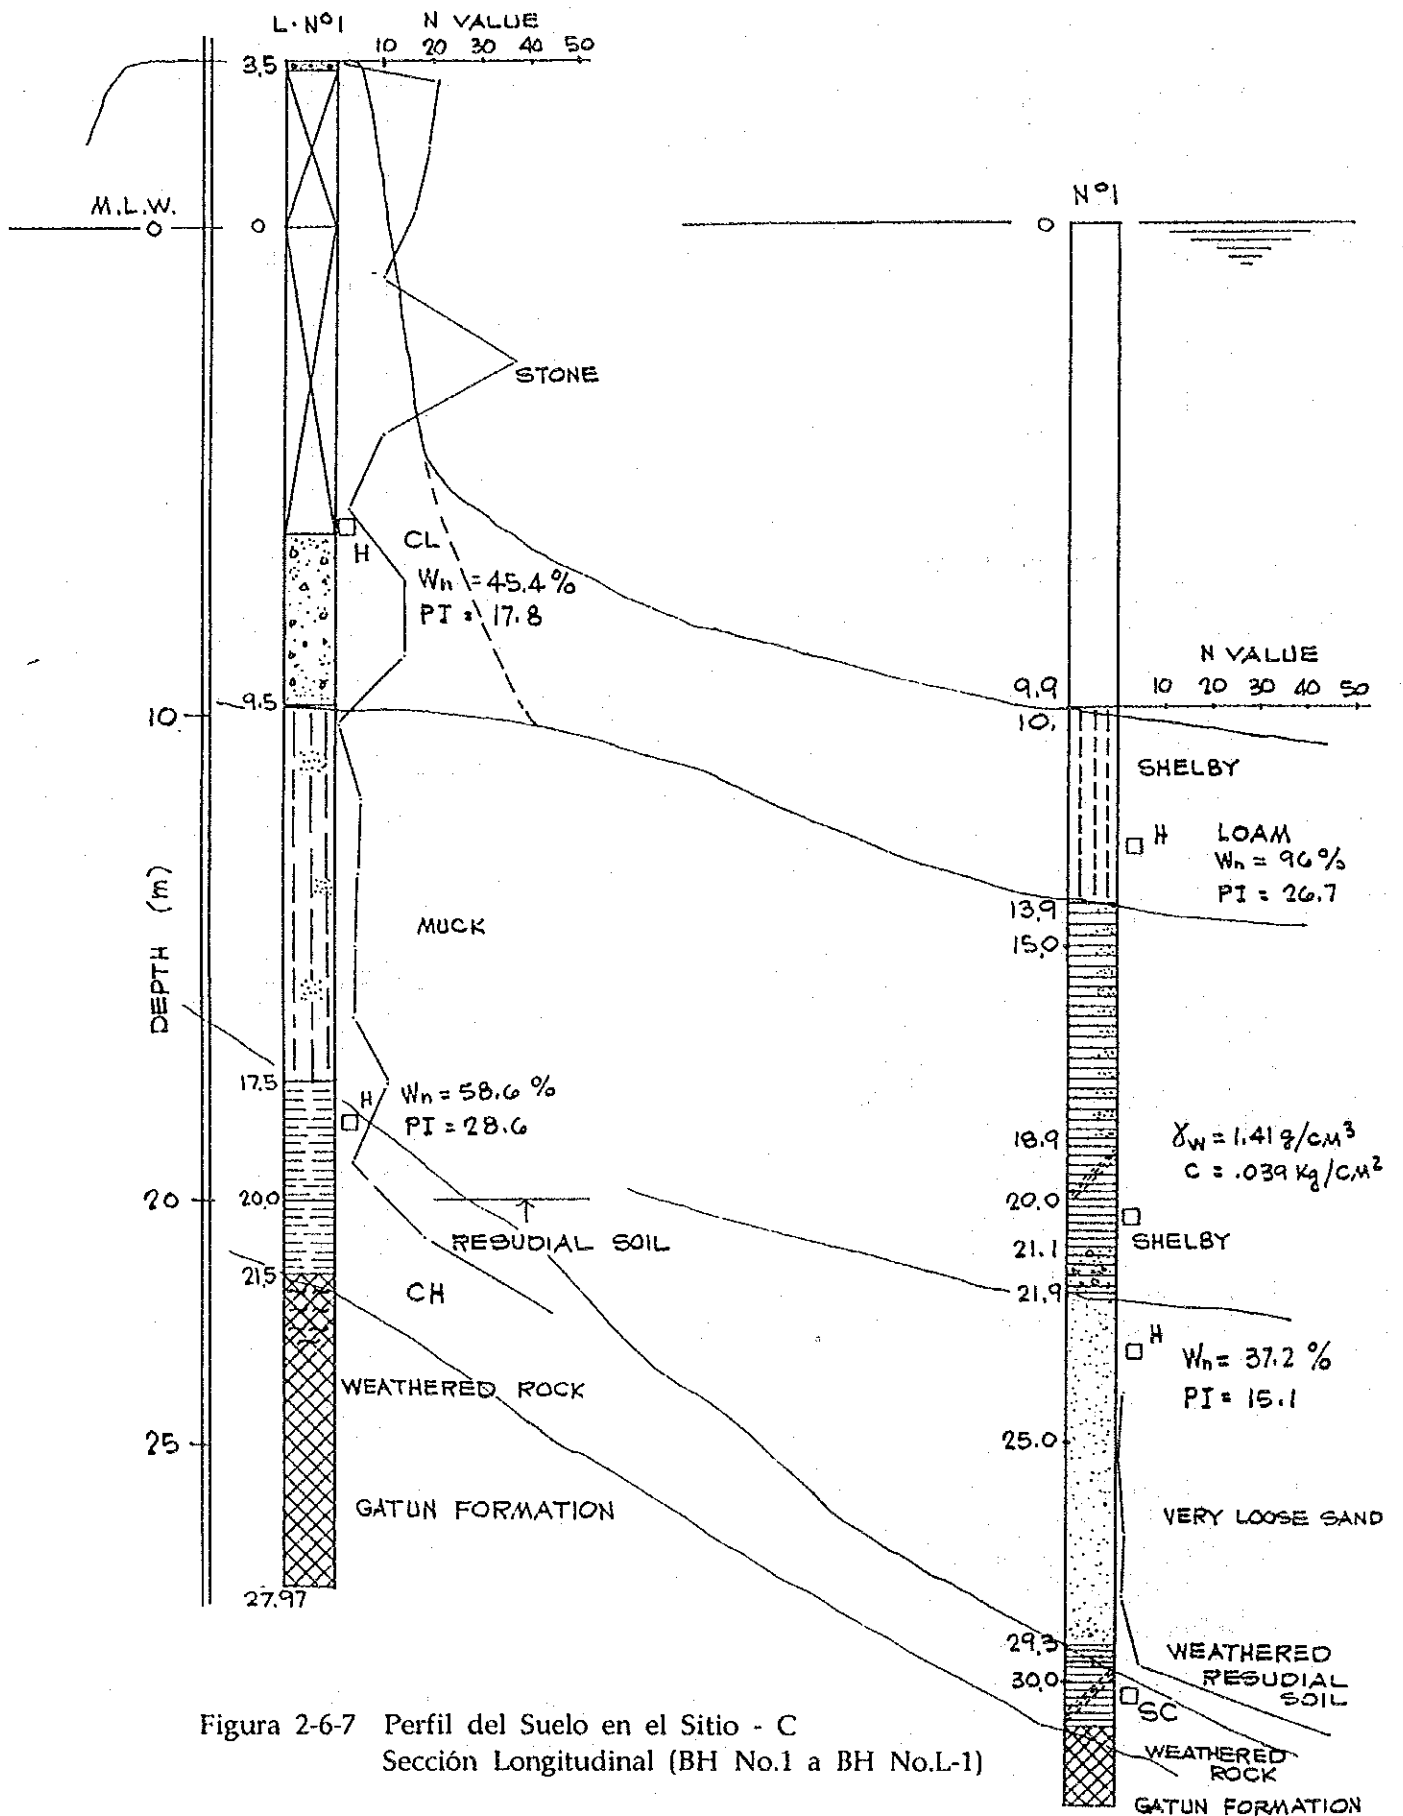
Perfil del Suelo en el Sitio - C
